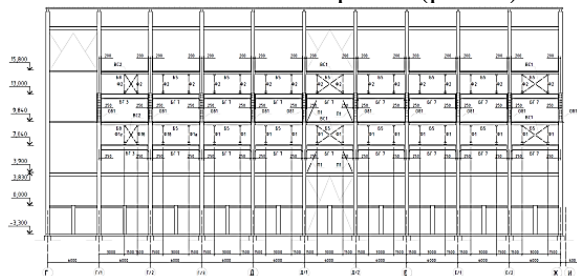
Расположение несущих балок и ферм перекрытий дополнительных этажей по оси 6.
